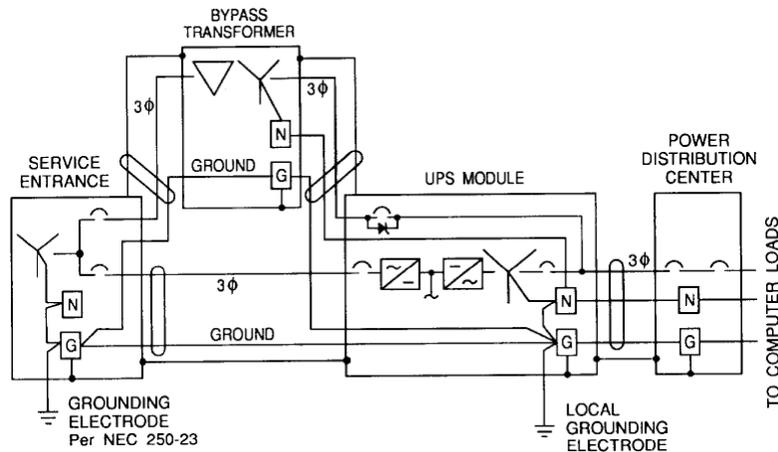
Configuración 2: UPS-bypass aislado – servicio eléctrico “Y”<sup>102</sup>
